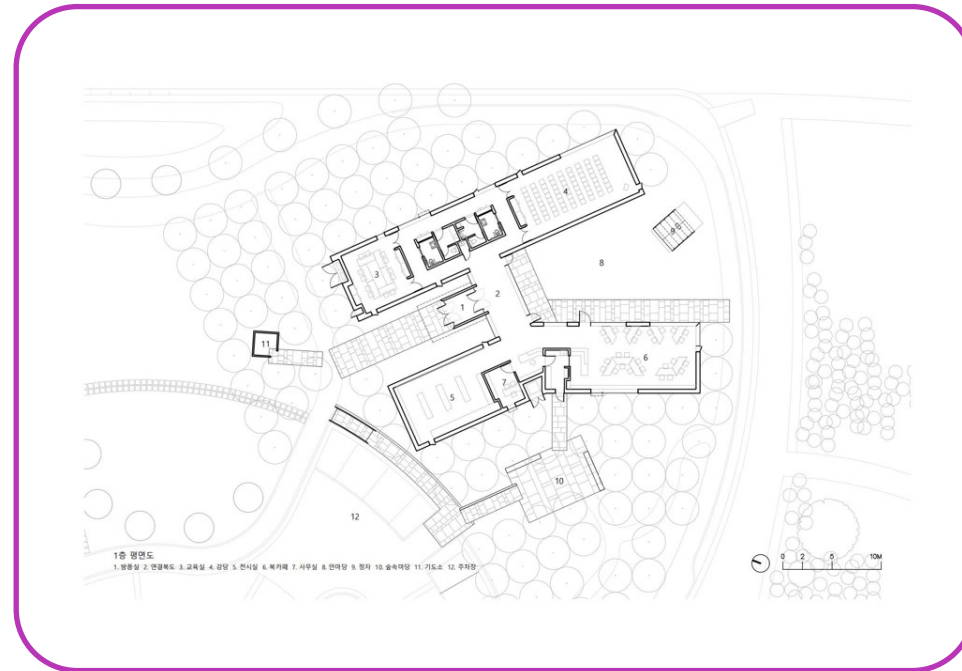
Imagen XX: Planta arquitectónica Centro Comunitario Je Jung-Ge
